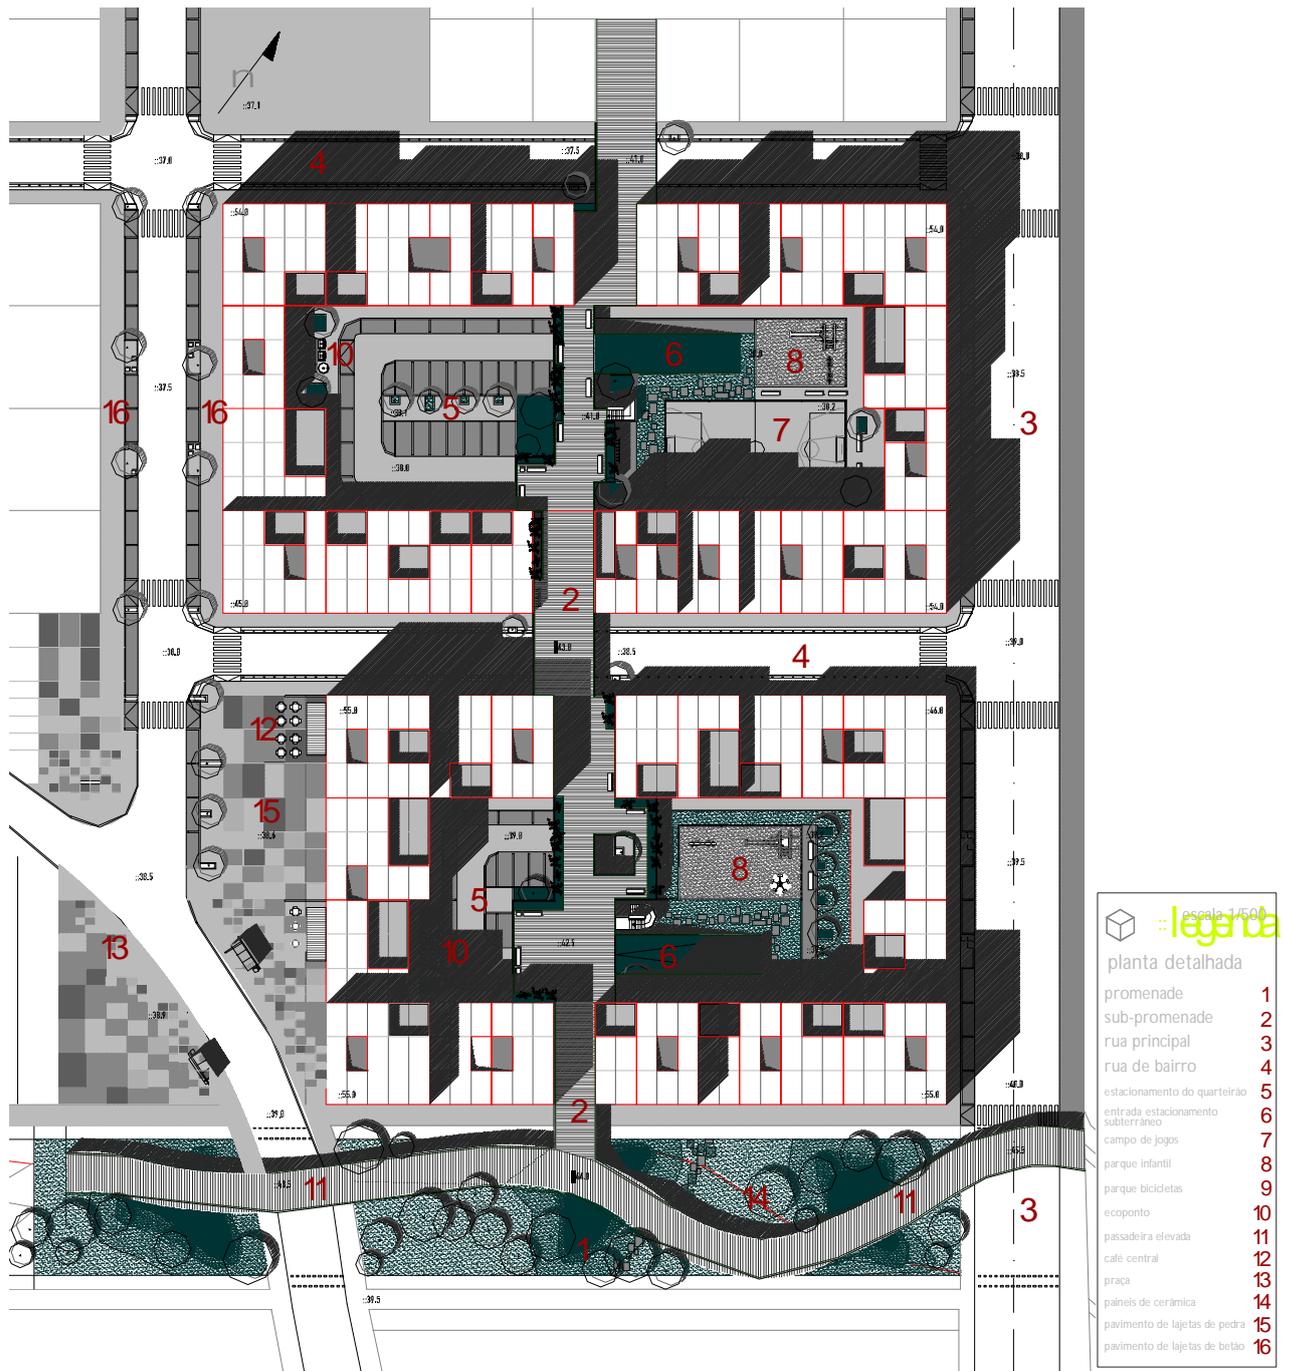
Plano de detalhe 2&2 – Planta detalhada elaborada à escala 1/500.
